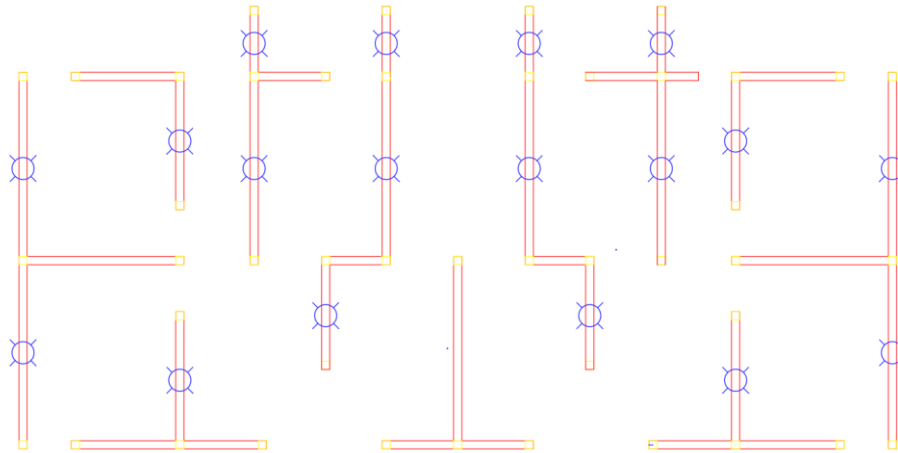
Ubicación de centro de columnas anchas en la dirección Y.
